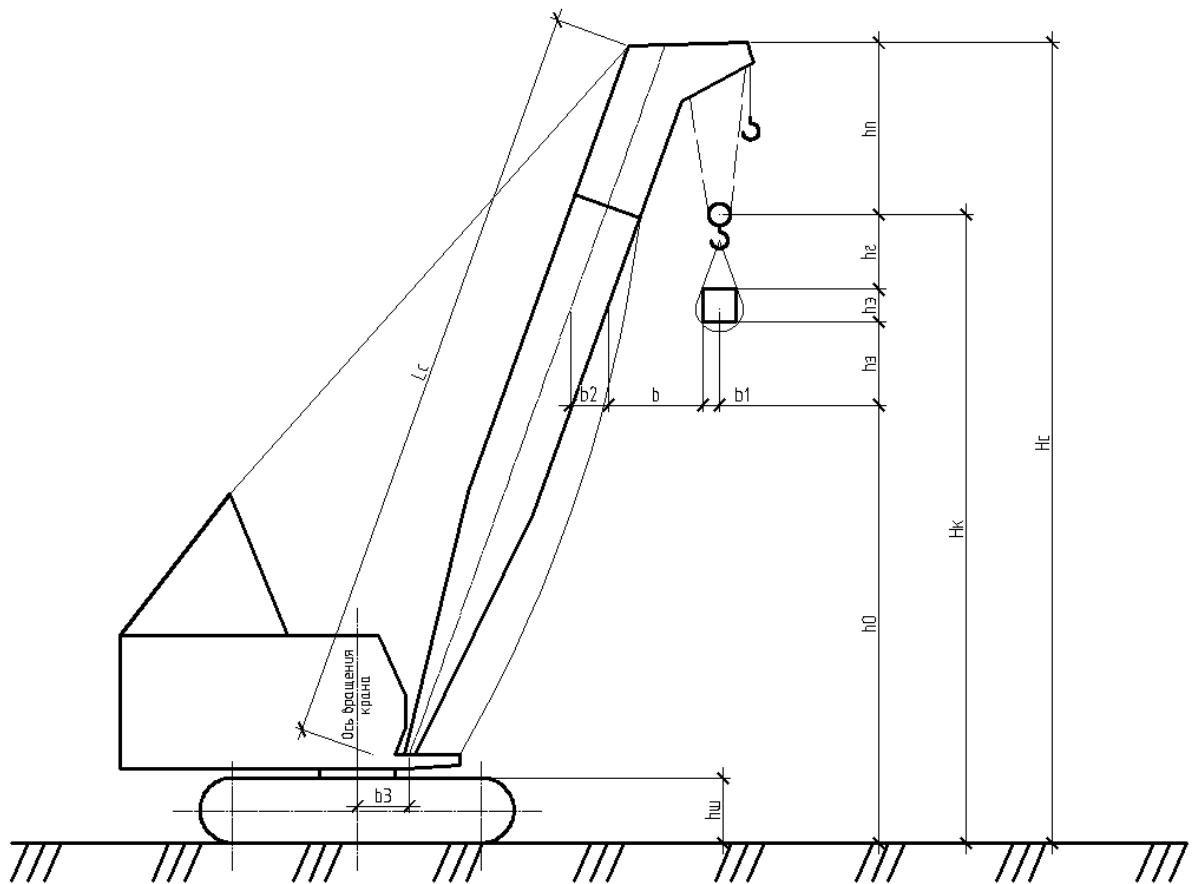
Схема к подбору крана для монтажа крупнопанельного жилого дома
